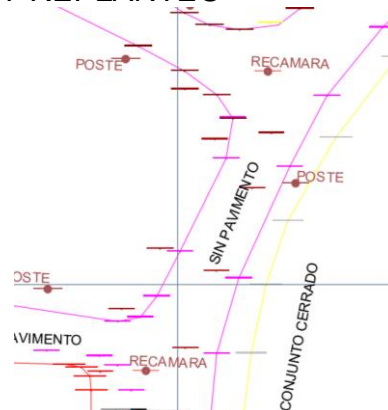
Plano levantamiento topográfico - Fuente: propia
